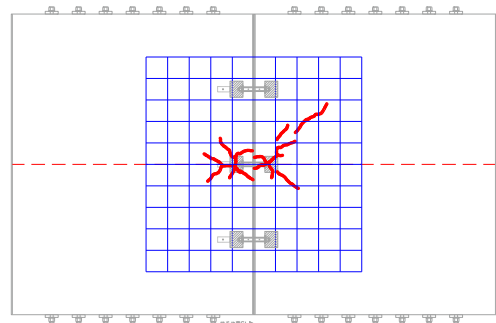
255kN 載荷 10 万回終了後のひび割れ状況
